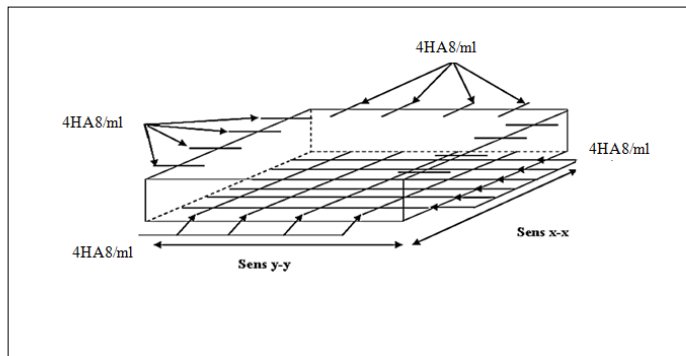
Schéma du ferrailage de la dalle du séchoir sur trois appuis.
